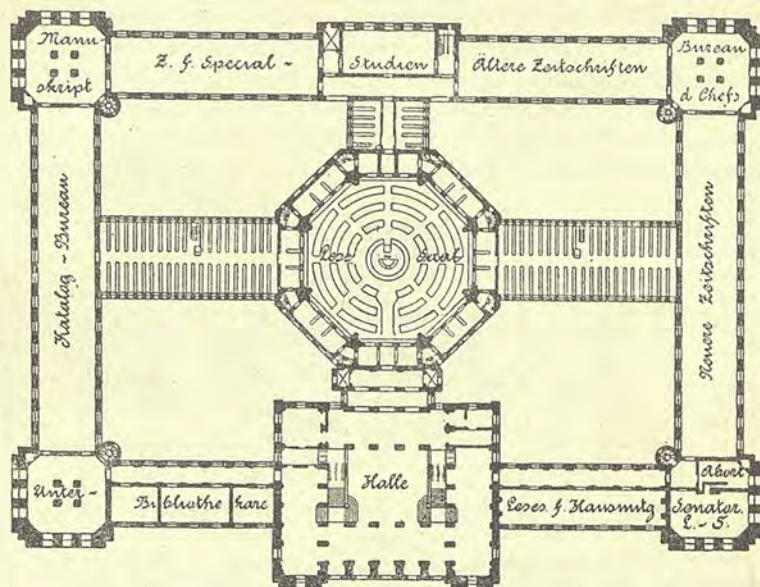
Secondo progetto per la biblioteca di Washington.
